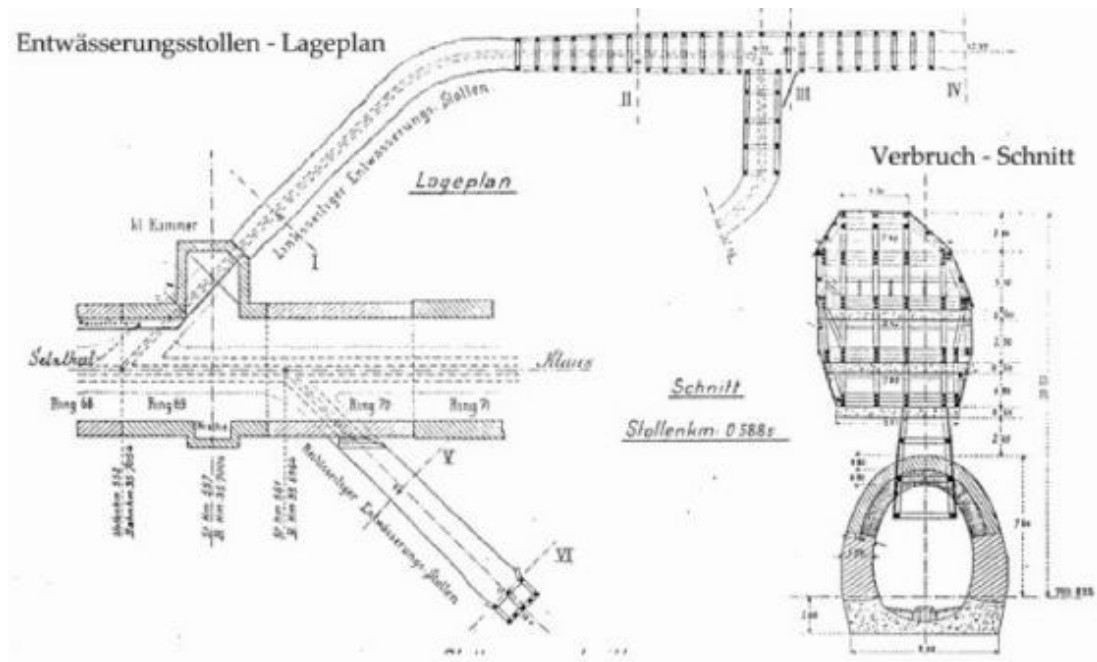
Lageplan Entwässerungsstollen des Bosruck-Eisenbahntunnels [10]
